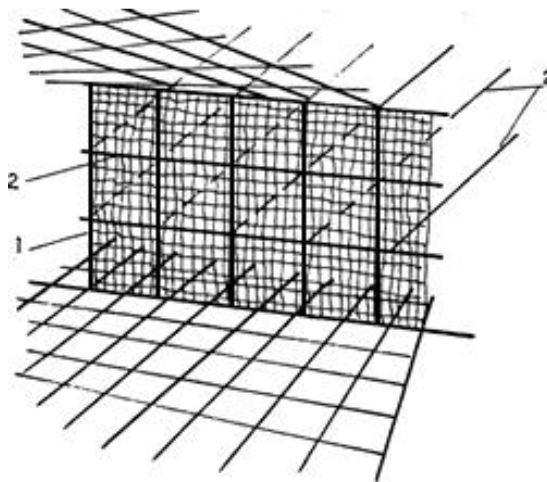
Внутренняя опалубка рабочего шва плиты:
